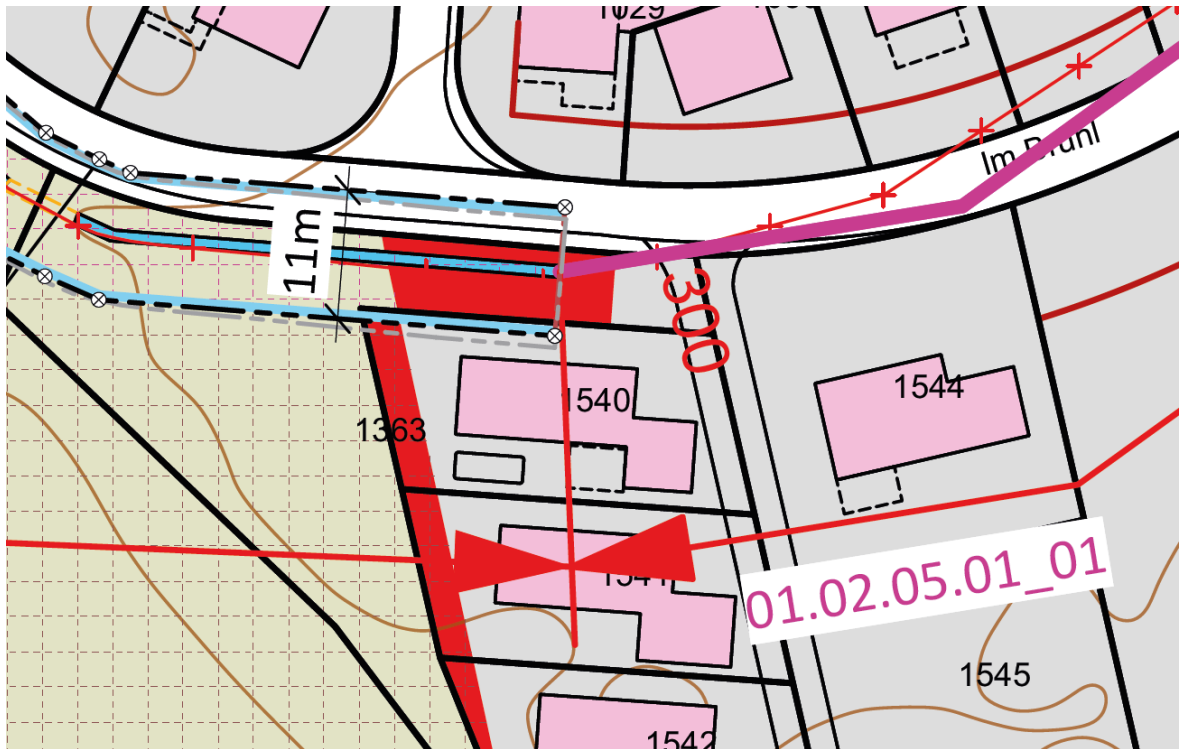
Ausschnitt aus Plan 17; eigene Darstellung
